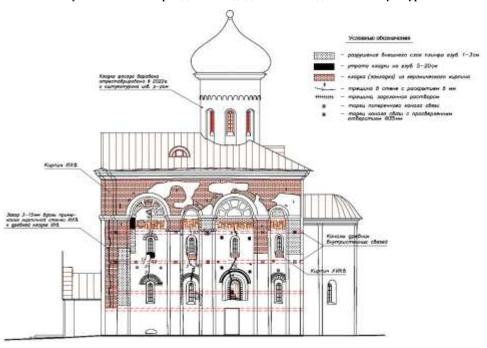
Южный фасад в 2023 г. после демонтажа поздних слоёв штукатурки
